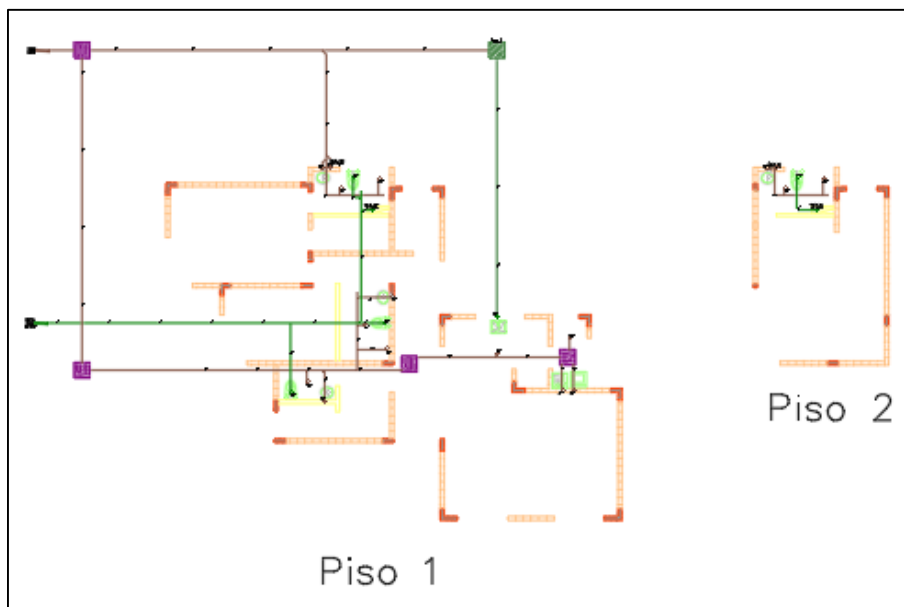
Red desagües proyecto Envigado construcción convencional.
